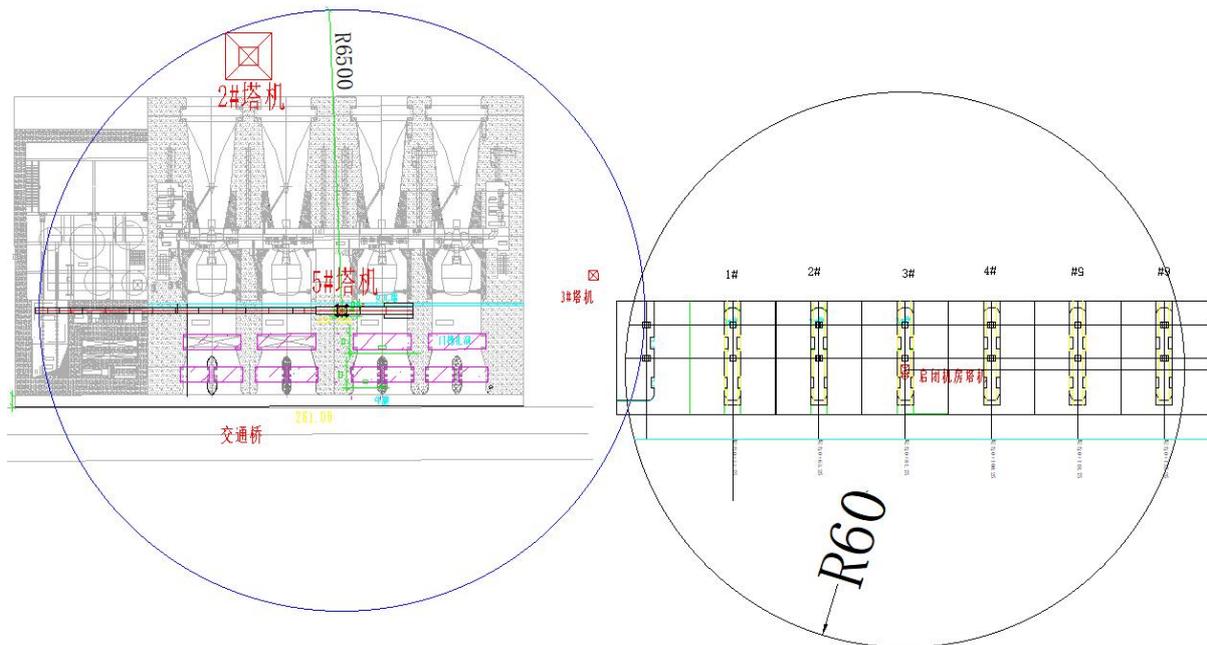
：发电厂上游 5#、排架柱 1#塔式起重机平面布置图
